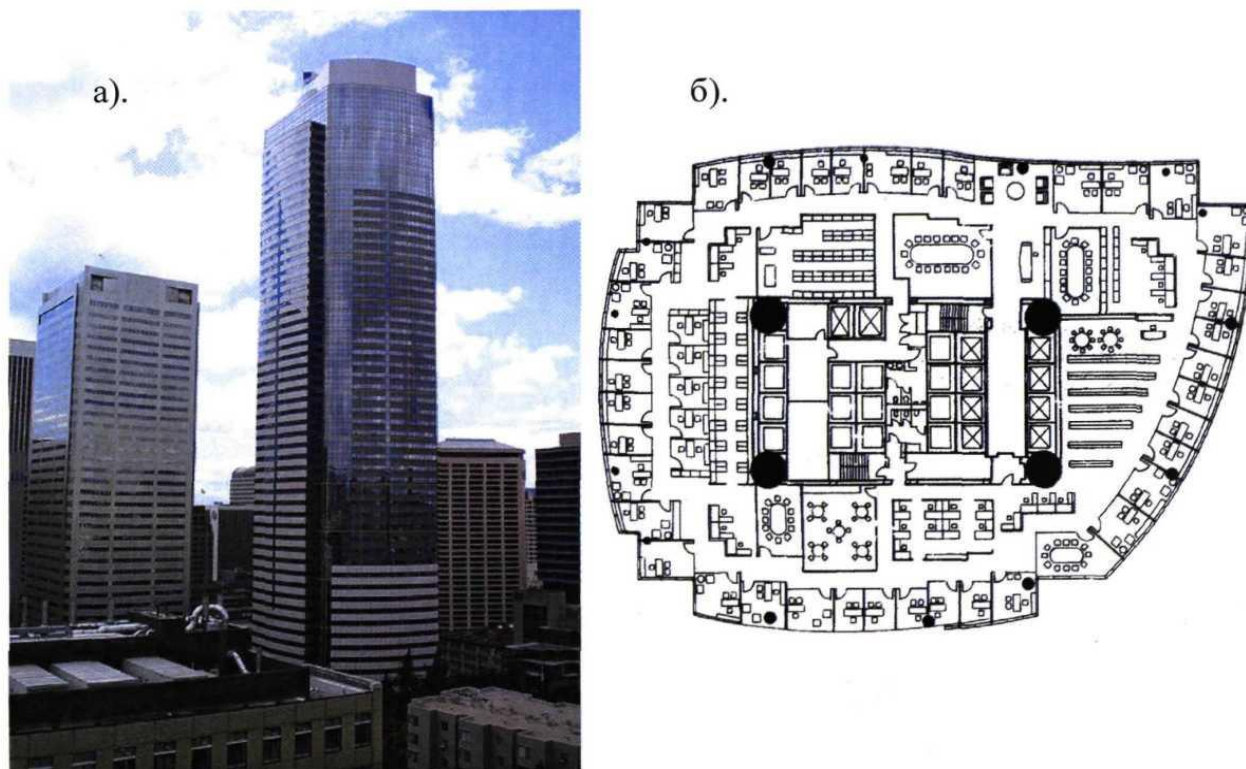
58-ми поверховий будинок «Two Union Square» з несучими конструкціями із трубобетона
